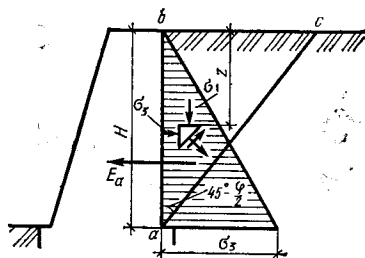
Определение давления сыпучих грунтов на подпорную стенку
